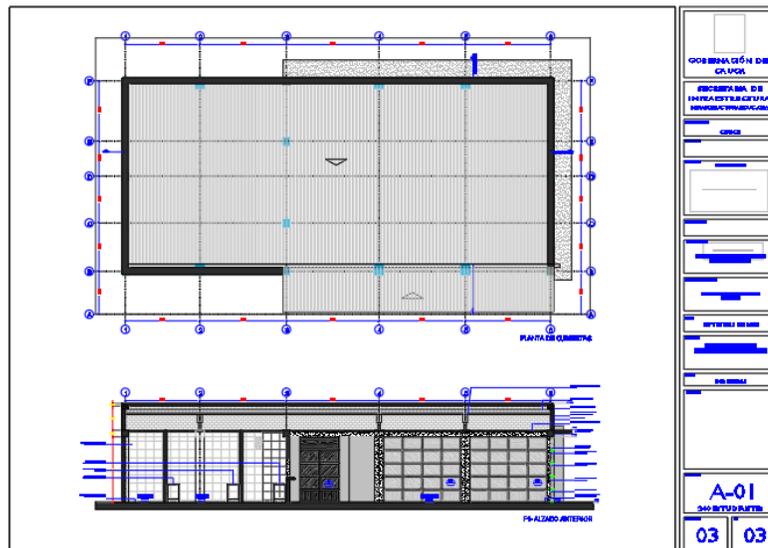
Diseño arquitectónico cubierta Restaurantes. Fuente: Arq. Juan Serrano
